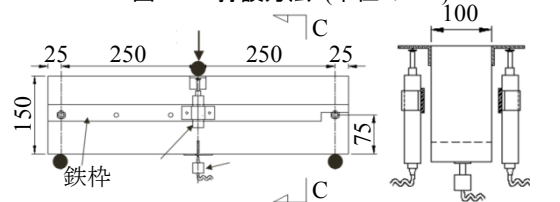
(a) 載荷方法 (切欠き供試体) (単位 : mm)
